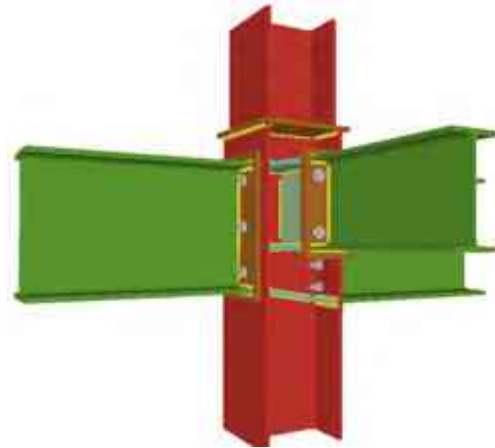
Imagen columna metálica articulada y soldada con vigas primaria y secundaria Fuente: datos obtenidos en google. 10/12/2014
